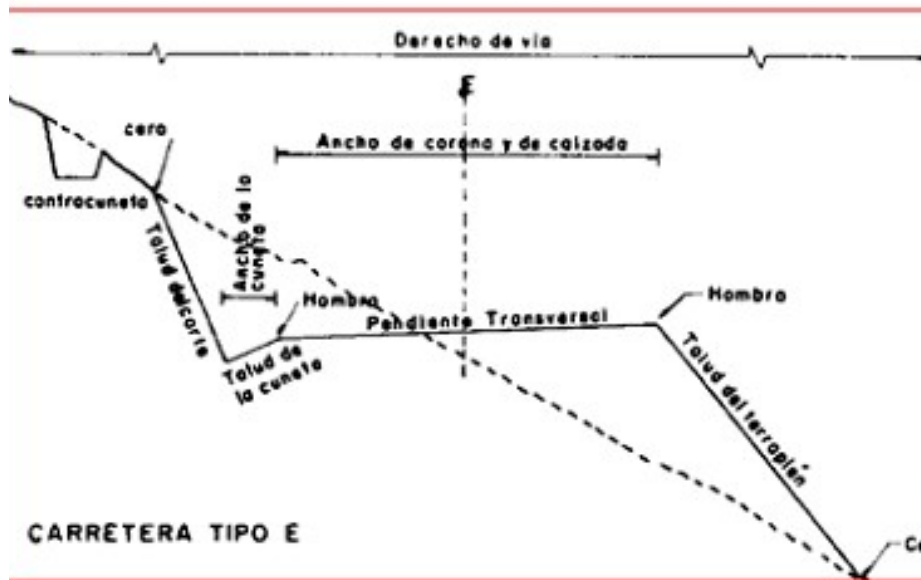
Secciones transversales, carreteras tipo: E por SCT
